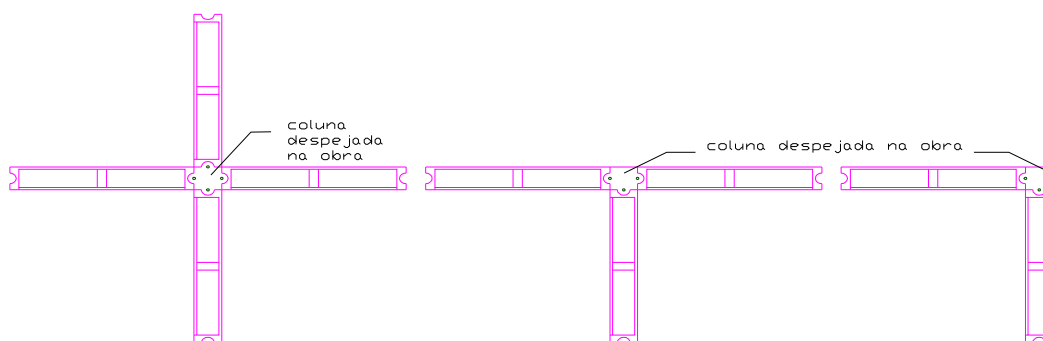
Conexões de painéis em esquinas e paredes intermédias para a primeira alternativa de sistema construtivo.
